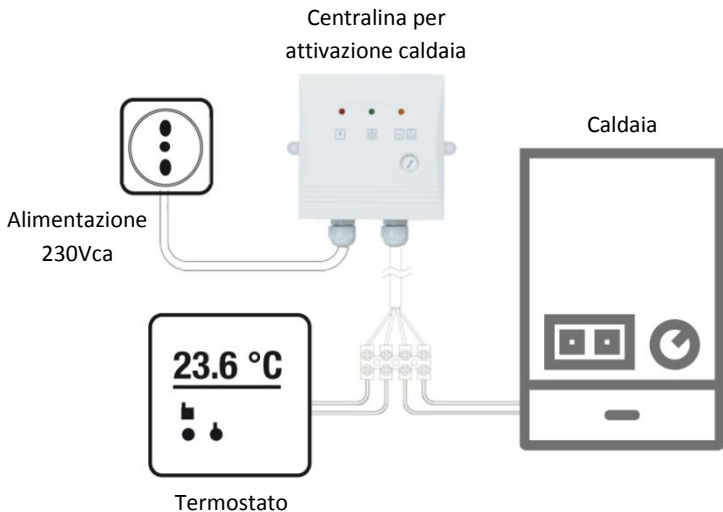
Schema di collegamento centralina per attivazione caldaia.
